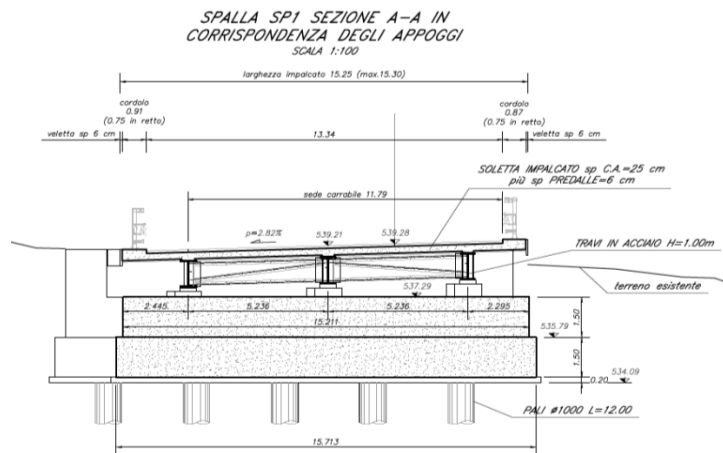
Sezione impalcato - Spalla SP1
